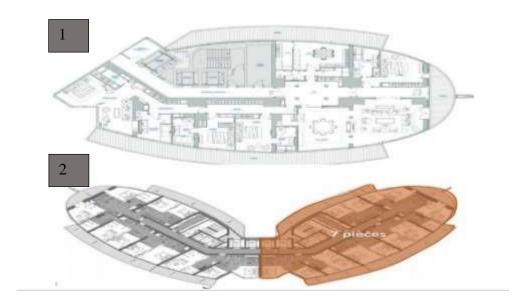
vues sur les plans de la tour : plan d'un appartement T5, étage 25 au 28ème étage
